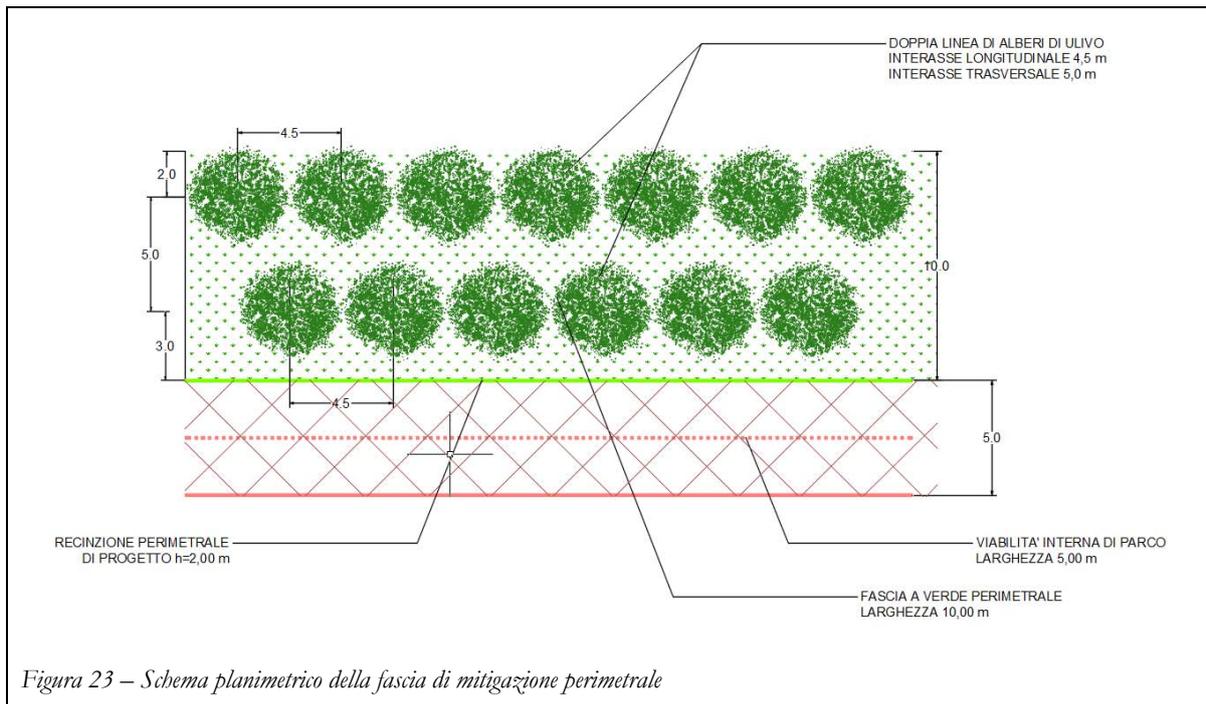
Schema planimetrico della fascia di mitigazione perimetrale
